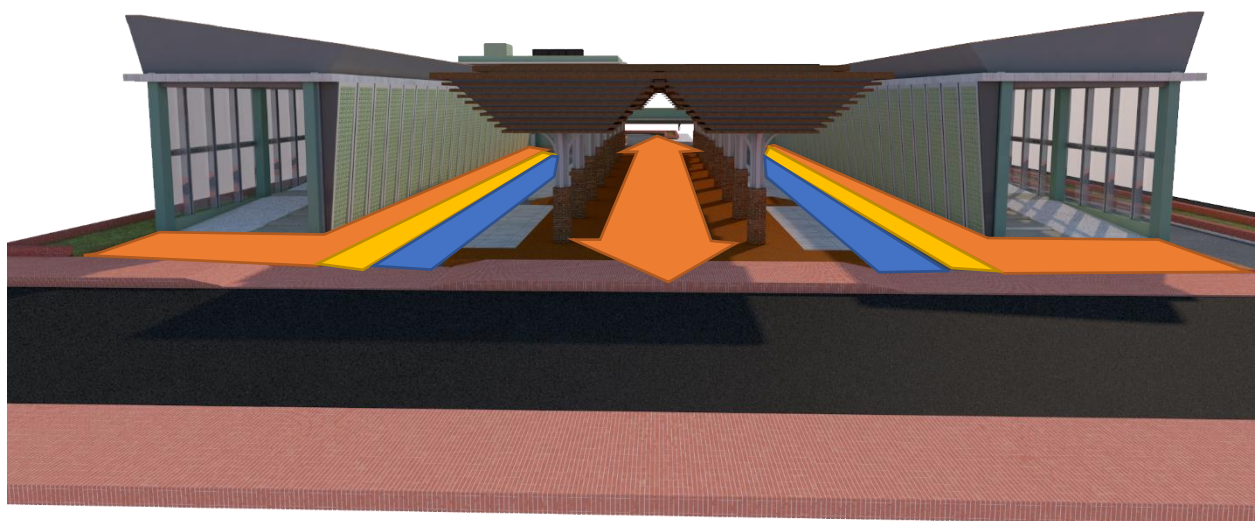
Sistem Sirkulasi Air pada Bangunan
